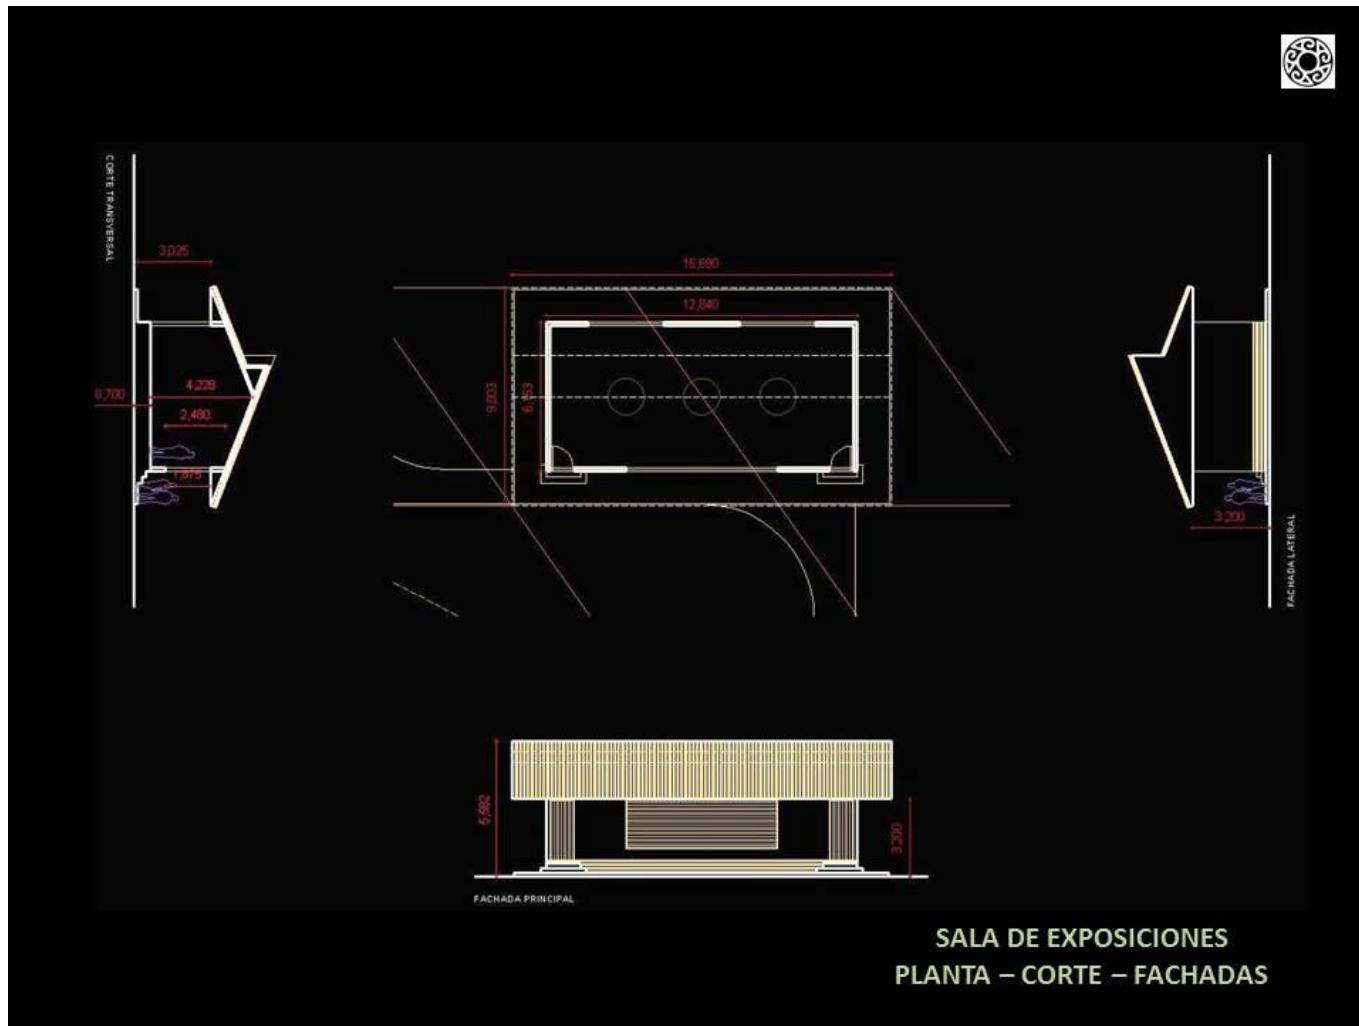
PLANTA, CORTE Y FACHADAS SALA DE PROYECCIONES
